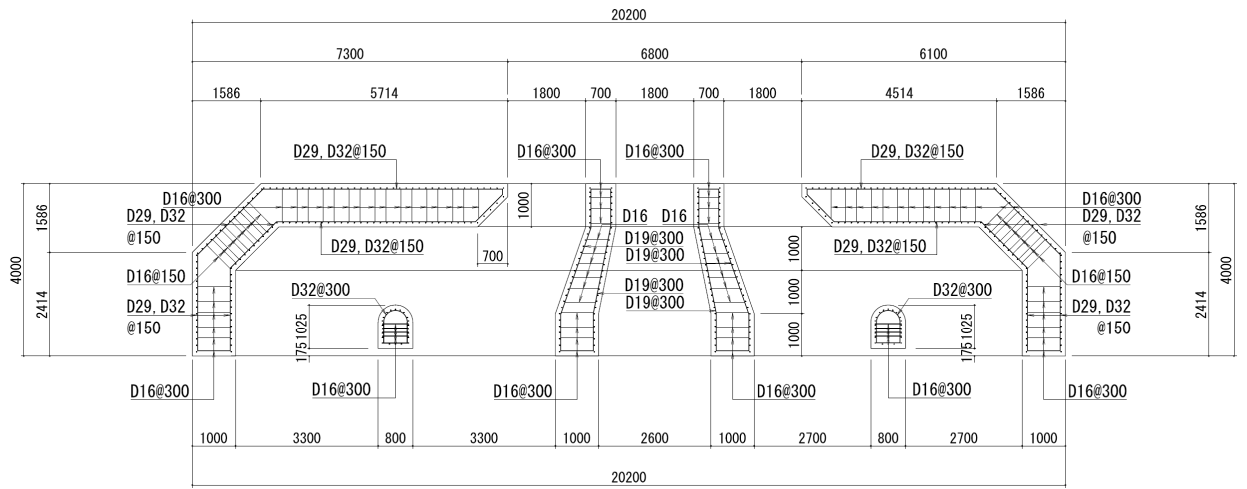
(3) 補機冷却用海水取水路の断面図 (北側, C-C 断面)
